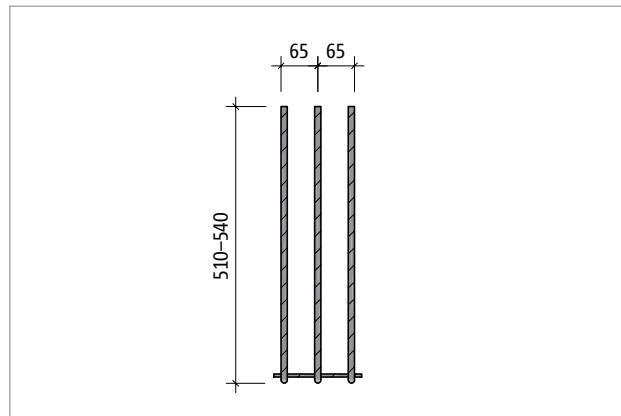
Schöck Sconnex® Typ W Part TB: Zulagebewehrung 3 Ø 12/65 mm; Bügel in der Seitenansicht
